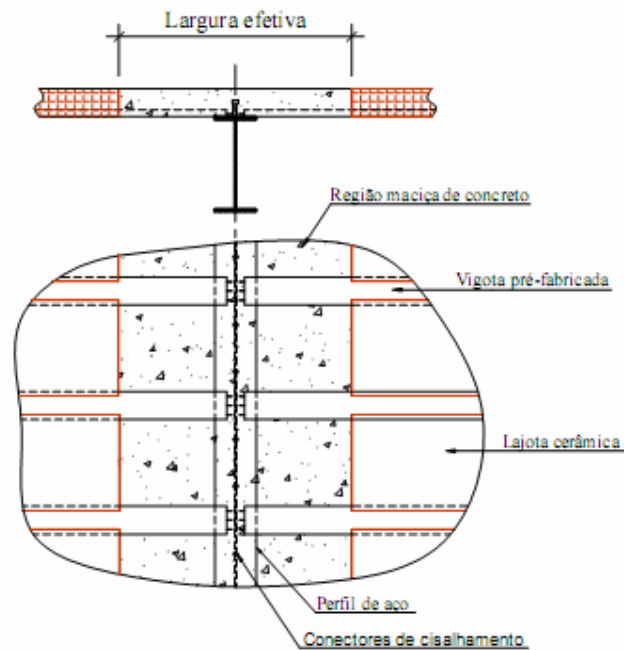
Largura efetiva considerada em vigas mistas com laje pré-moldada – FABRIZZI (2007)
